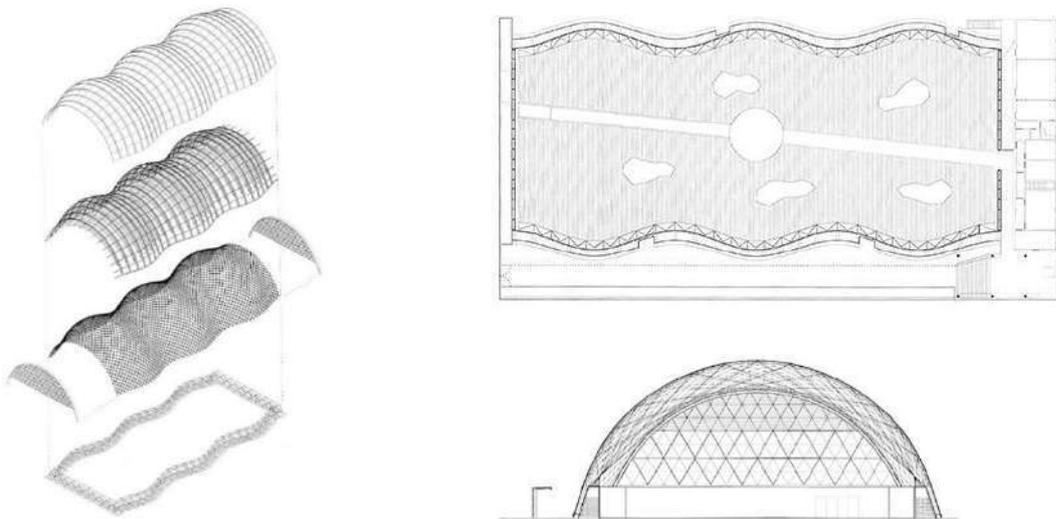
De izquierda a derecha y de arriba a abajo, axonometría explotada de envolvente de celosía y cubierta, planta del pabellón y alzado lateral. Disponible en: <https://arquitecturaviva.com/obras/pabellon-de-japon-en-expo-2000>
